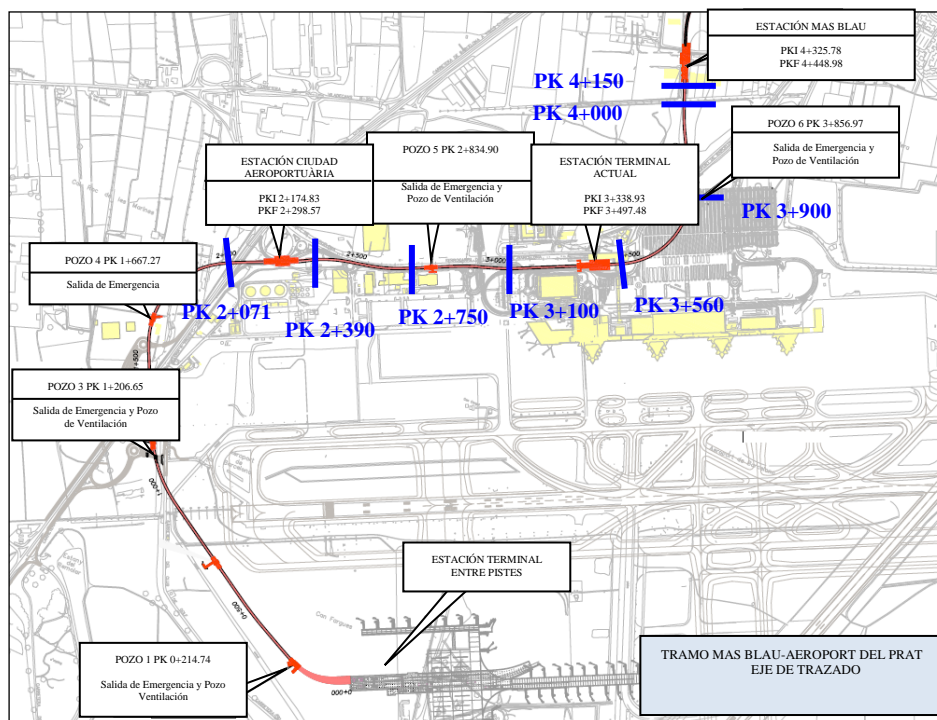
Trazado en planta del Tramo T1D (Mas Blau _ Aeroport T1) y situación de las cubetas transversales de asiento
